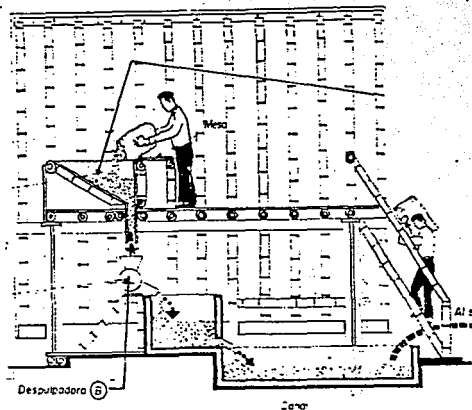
Corte longitudinal de la planta beneficiadora en el que se muestran las diversas operaciones del
